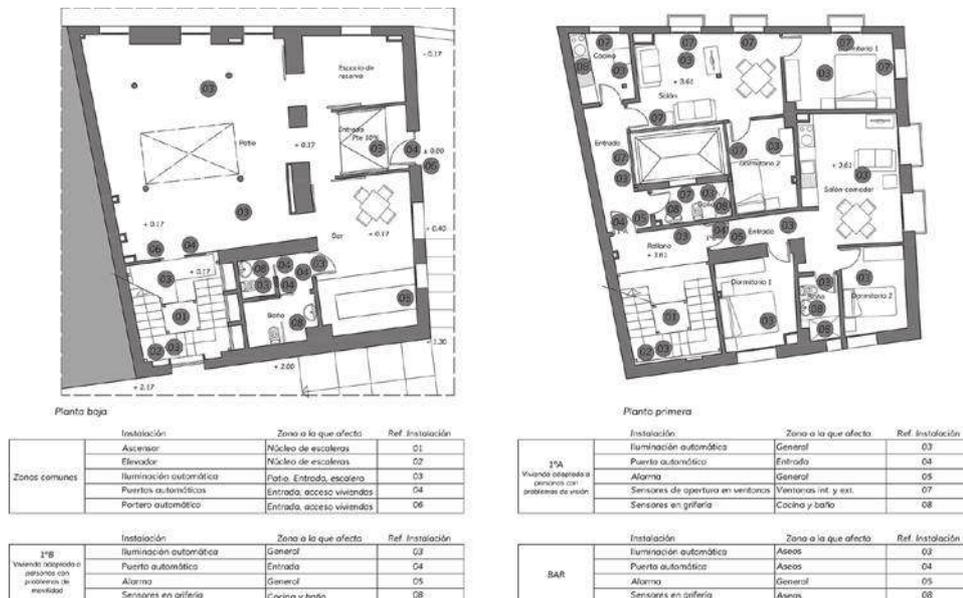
Plano con medidas domóticas a instalar y ubicación en restauración de edificio de viviendas plurifamiliares. Plantas baja y primera.
